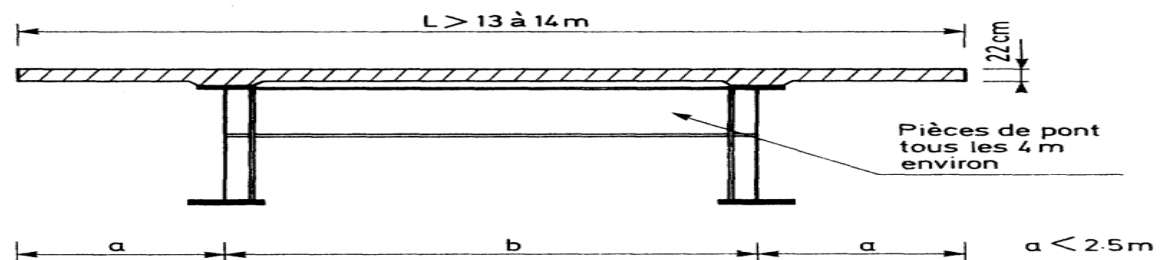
schéma d'un pont de type bipoutre à pièces de pont.
